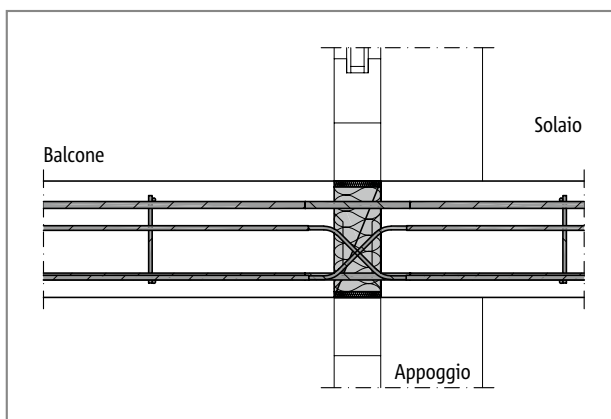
Schöck Isokorb® T tipo DL: sezione costruttiva; solaio piano
